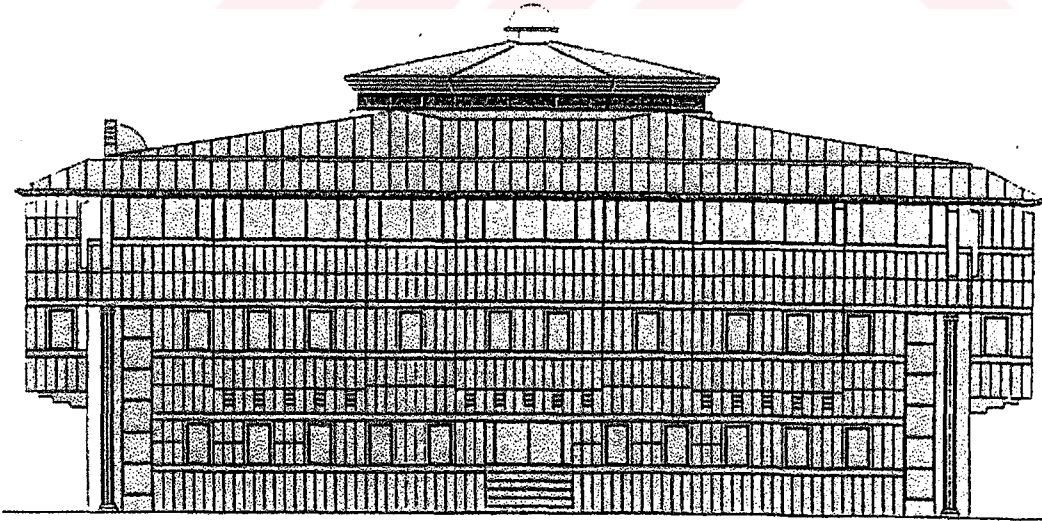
b: B.Ü. Doğu Kampusu; Spor salonu Planı
